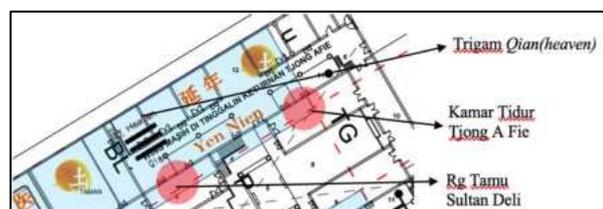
Pemetaan Zona Baik Pada Rumah Tjong A Fie
